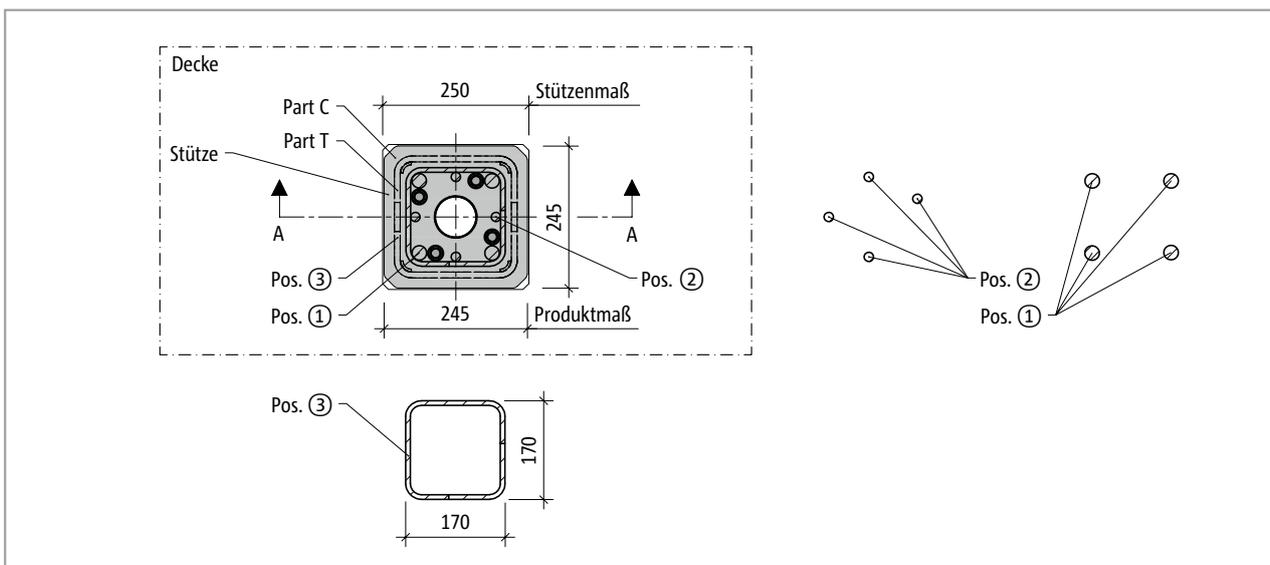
Schöck Scconnex® Typ P: Bauseitige Bewehrung im Stützenquerschnitt
